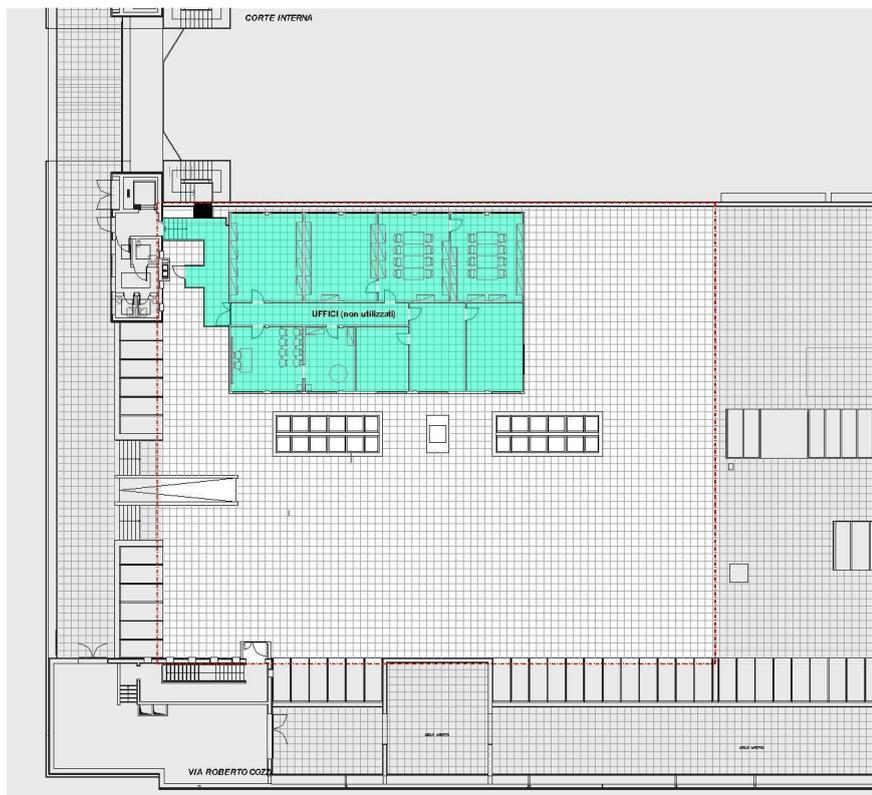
Stato di fatto – Pianta coperture con evidenziazione uffici in struttura prefabbricata (da demolire)
